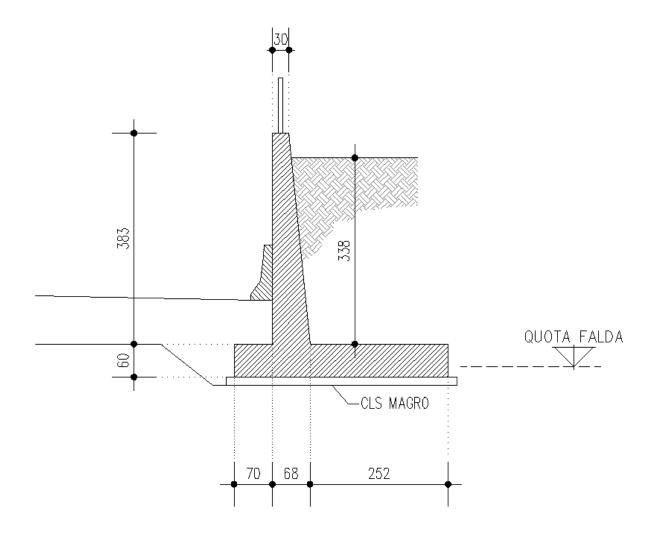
GEOMETRIA DELLA SEZIONE DEL MURO AD L
